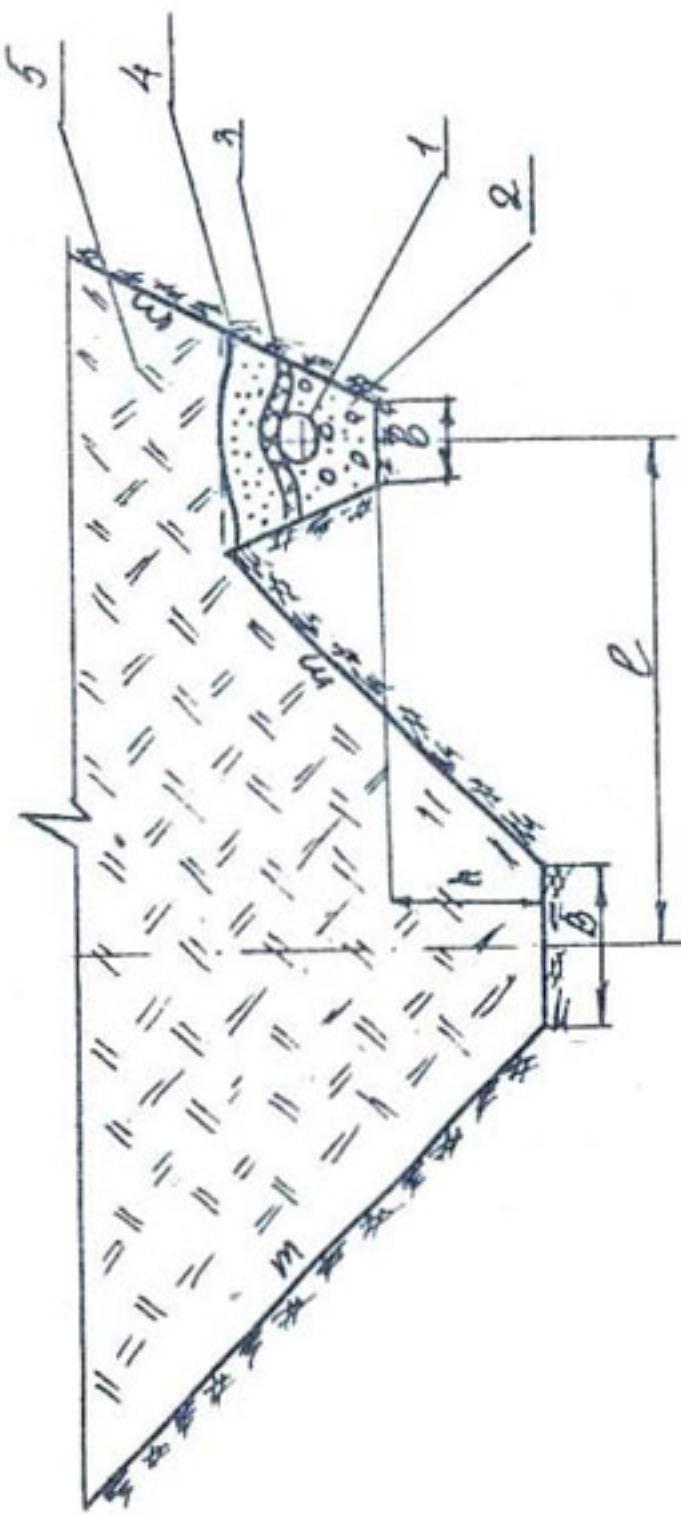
I. Схема конструкции дренажных фильтров для глубокого горизонтального трубчатого дренажного дrenaажа с искусственно агрегированым грунтом (метод полки).
